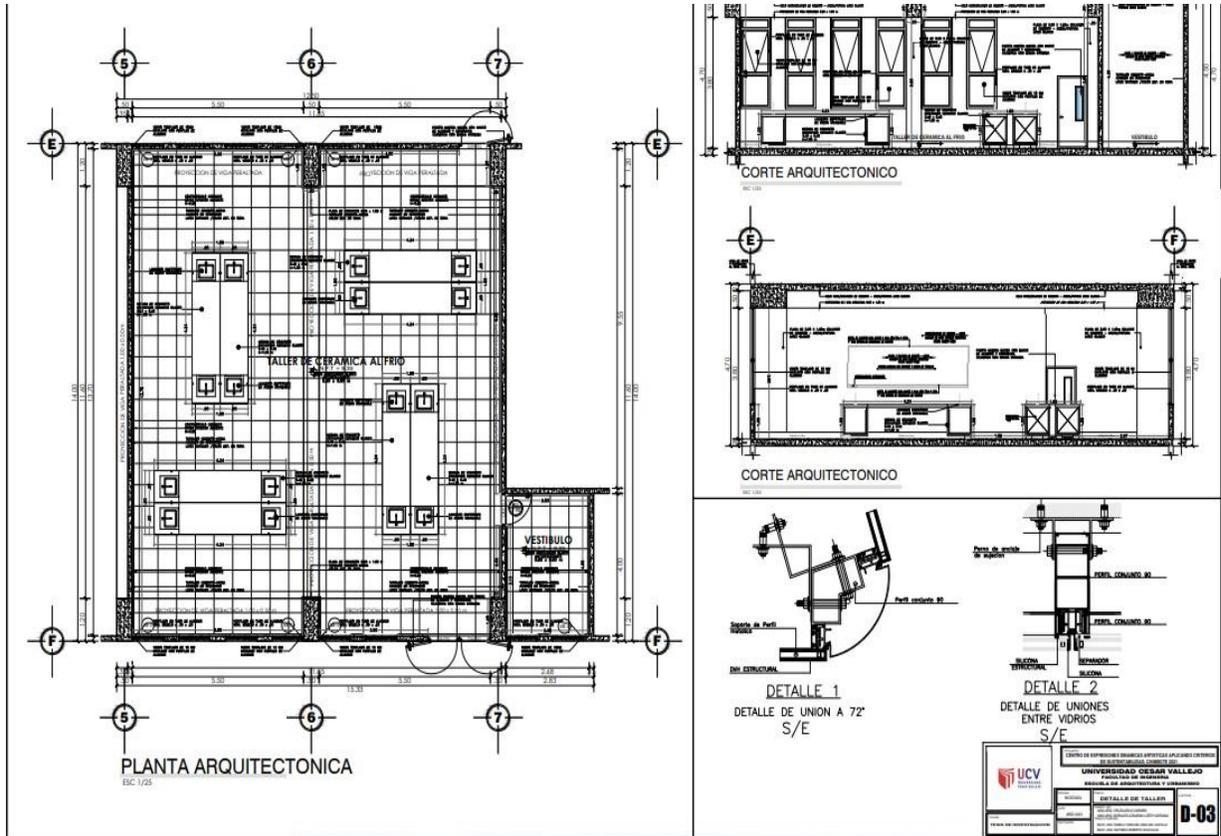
Plano de Detalles. Fuente: Elaboración Propia
